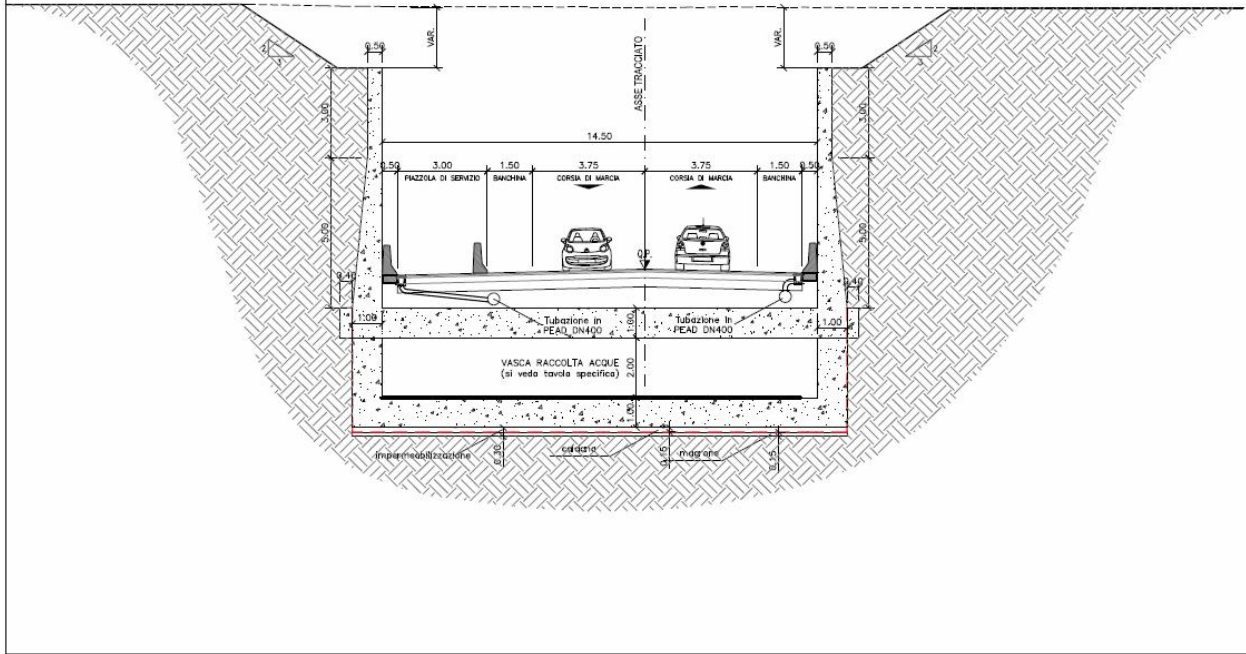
Sezione tipo - Galleria artificiale S.P.n.101
